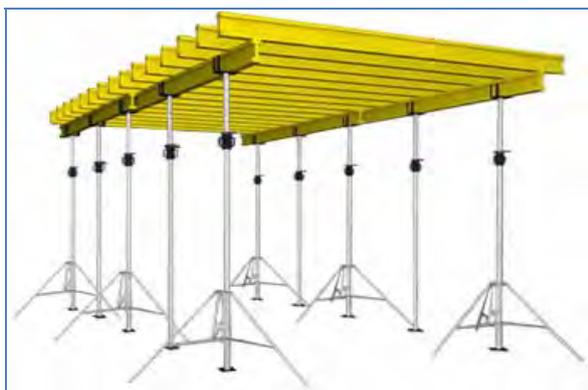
Опалубка перекрытий на телескопических стойках
